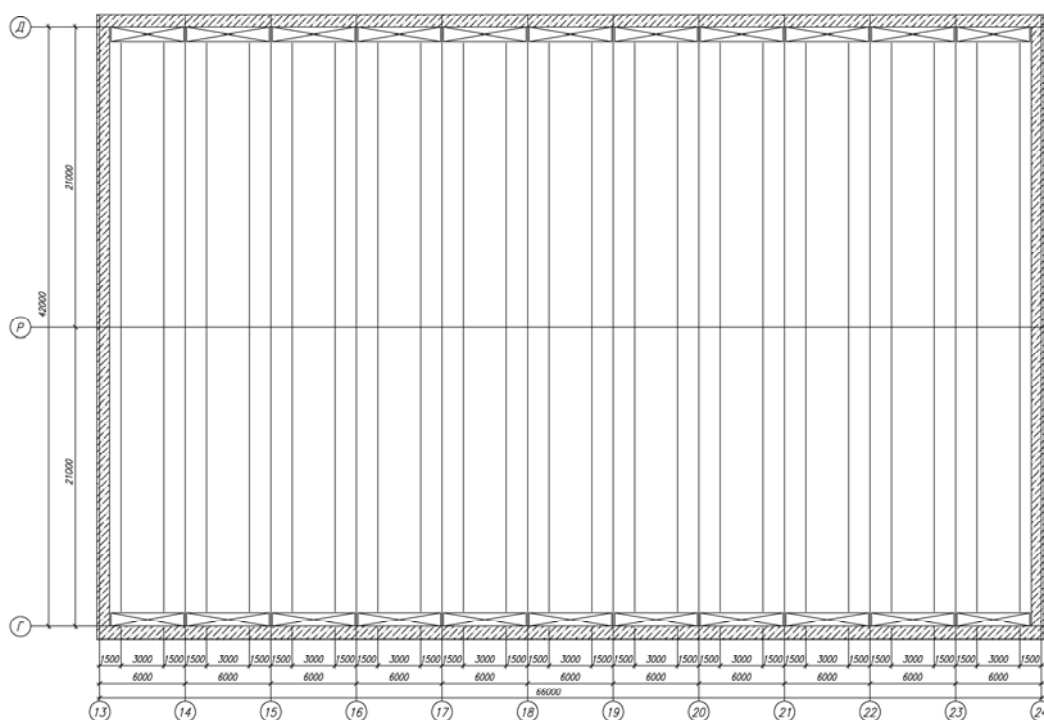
Схема расположения монтажных блоков несъемной опалубки
